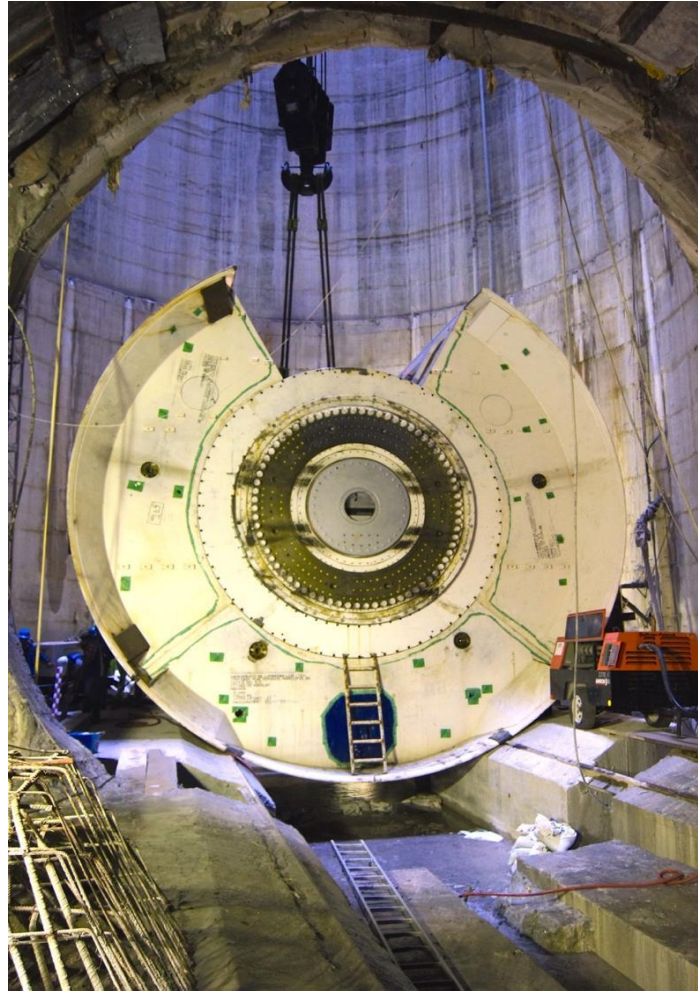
Armado de las cuatro secciones del accionamiento principal.⁹⁴
